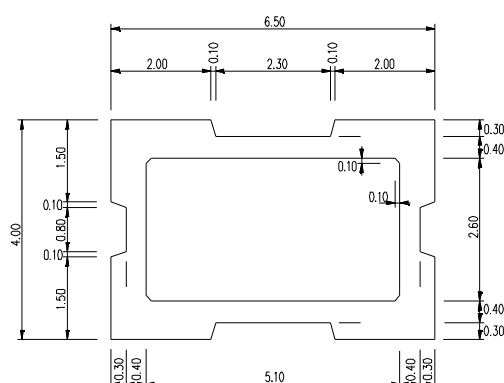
Secção transversal dos pilares P1 a P4.
